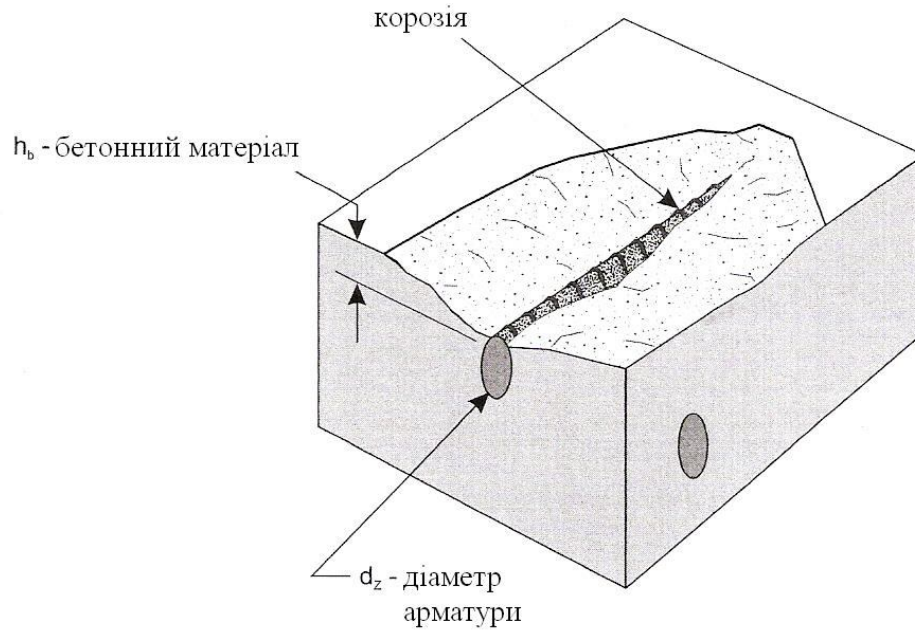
Зразок пошкодженого залізобетону з оголеною в зоні відшарування бетонної матриці сталевую арматурою.
